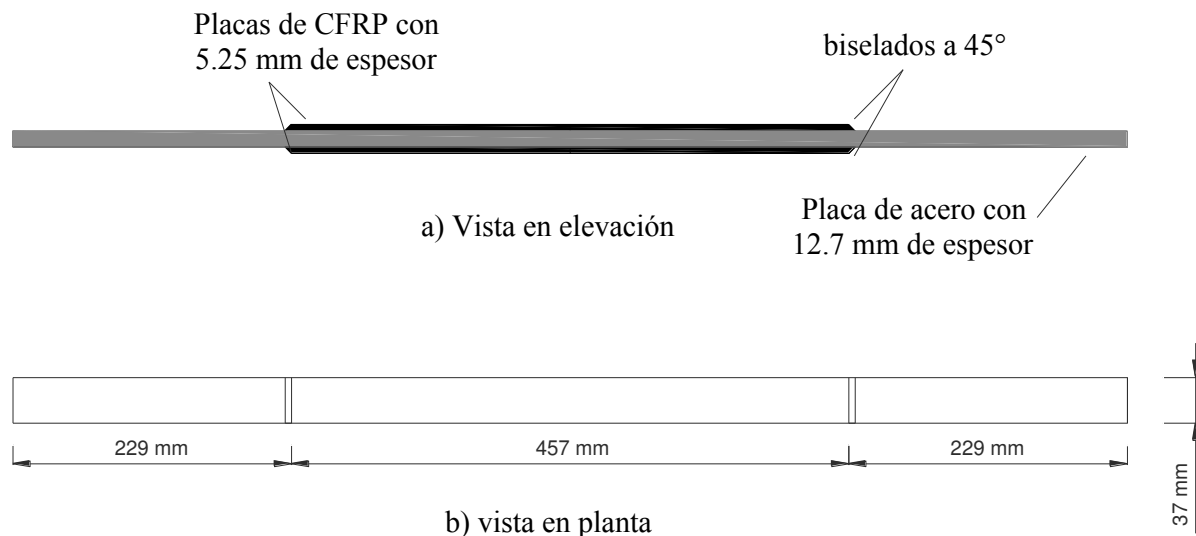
Placa de acero reforzada con placas CFRP y configuración del adhesivo.
